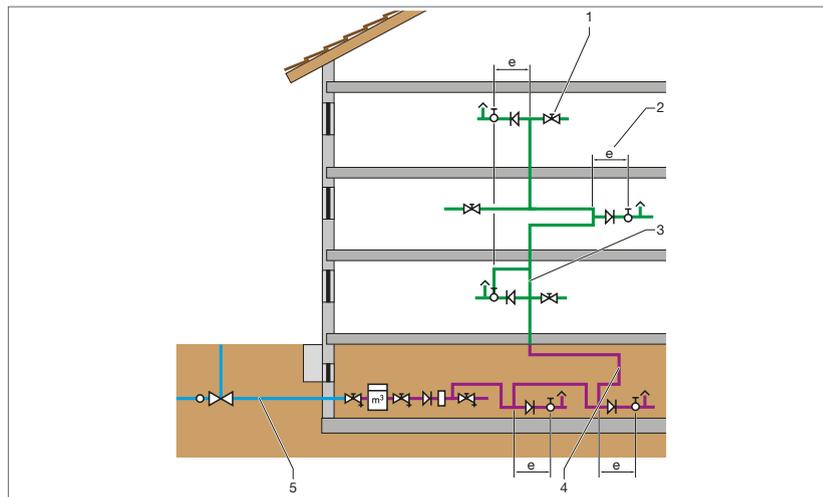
Trinkwasser-Installation mit Wandhydrant Typ S
